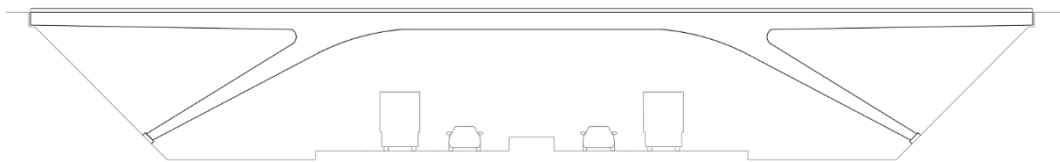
Schema ed esempio di cavalcavia a telaio con piedritti inclinati
